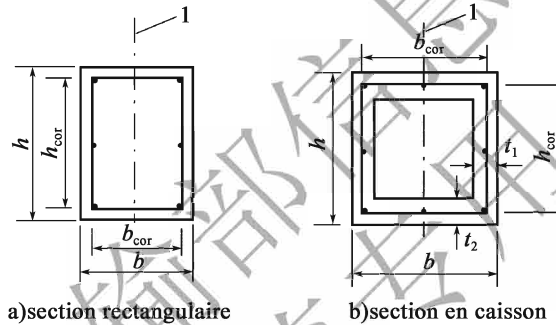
Eléments sollicités à la torsion, de section rectangulaire et de section caisson
